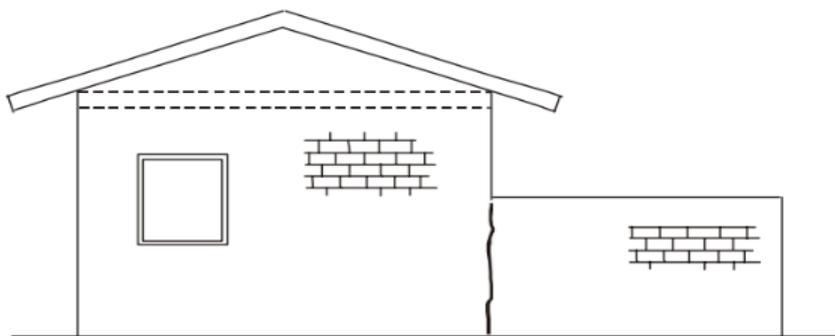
Fissura vertical por deficiência de amarração.
